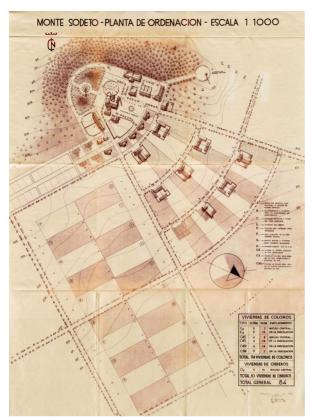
Planta de ordenación del pueblo de Sodeto, por el arquitecto Santiago Lagunas, 1956 (Fuente: AHPZ).
